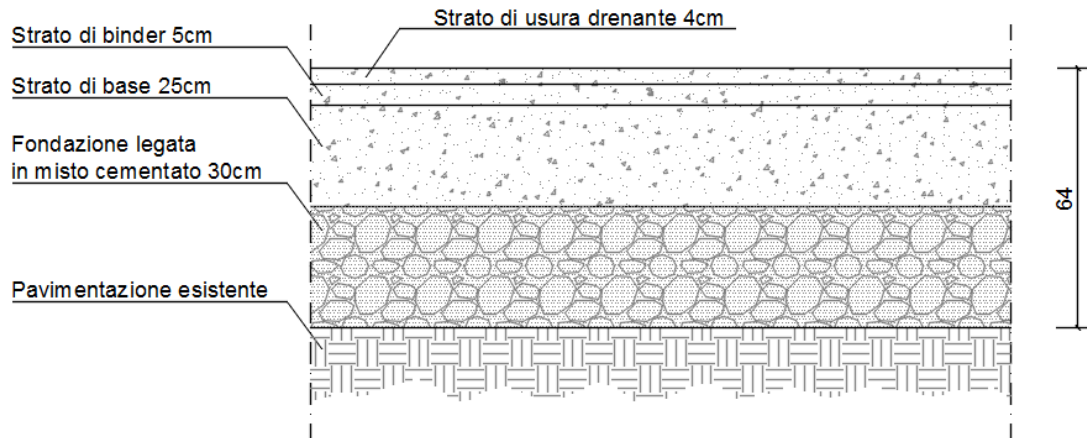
Pacchetto di ripristino pavimentazione autostrada TIPO P5
